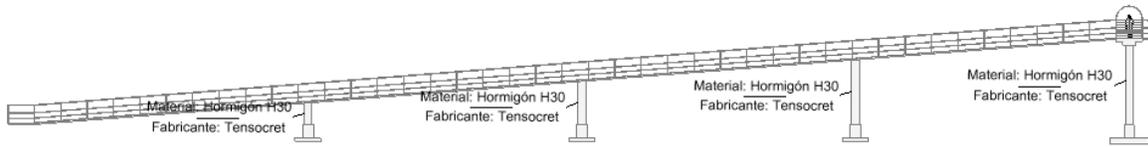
Perfil longitudinal de la pasarela peatonal, utilizando etiquetas para mostrar el tipo de material y fabricante de las columnas estructurales.
